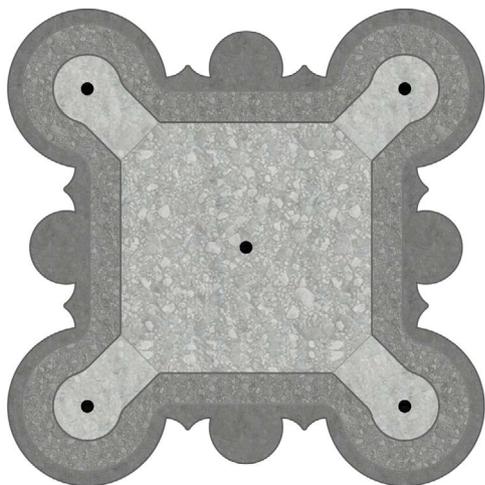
Detalle sección columna nave. Dibujo de Hugo Ventura Rodríguez.
